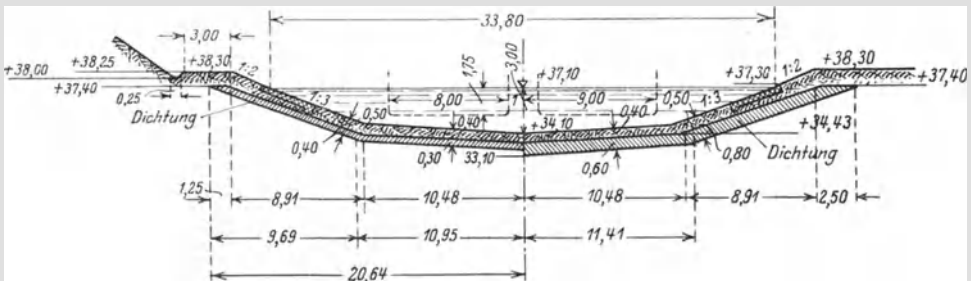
Querschnitt in Dichtungsstrecke. Großschiffahrtsweg Berlin-Stettin. Maßstab 1 : 500.
